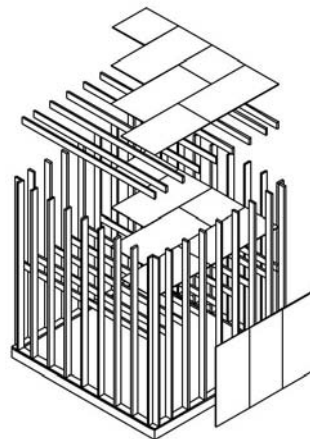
Schema Balloon-Frame-Bauweise
